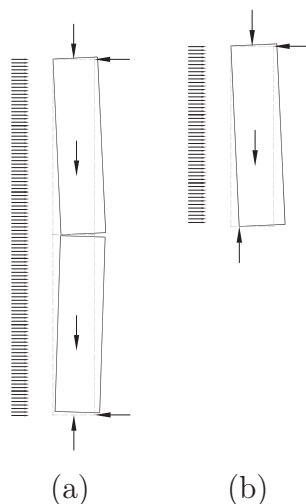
Effet d'arche après fissuration d'un mur de maçonnerie non armée
